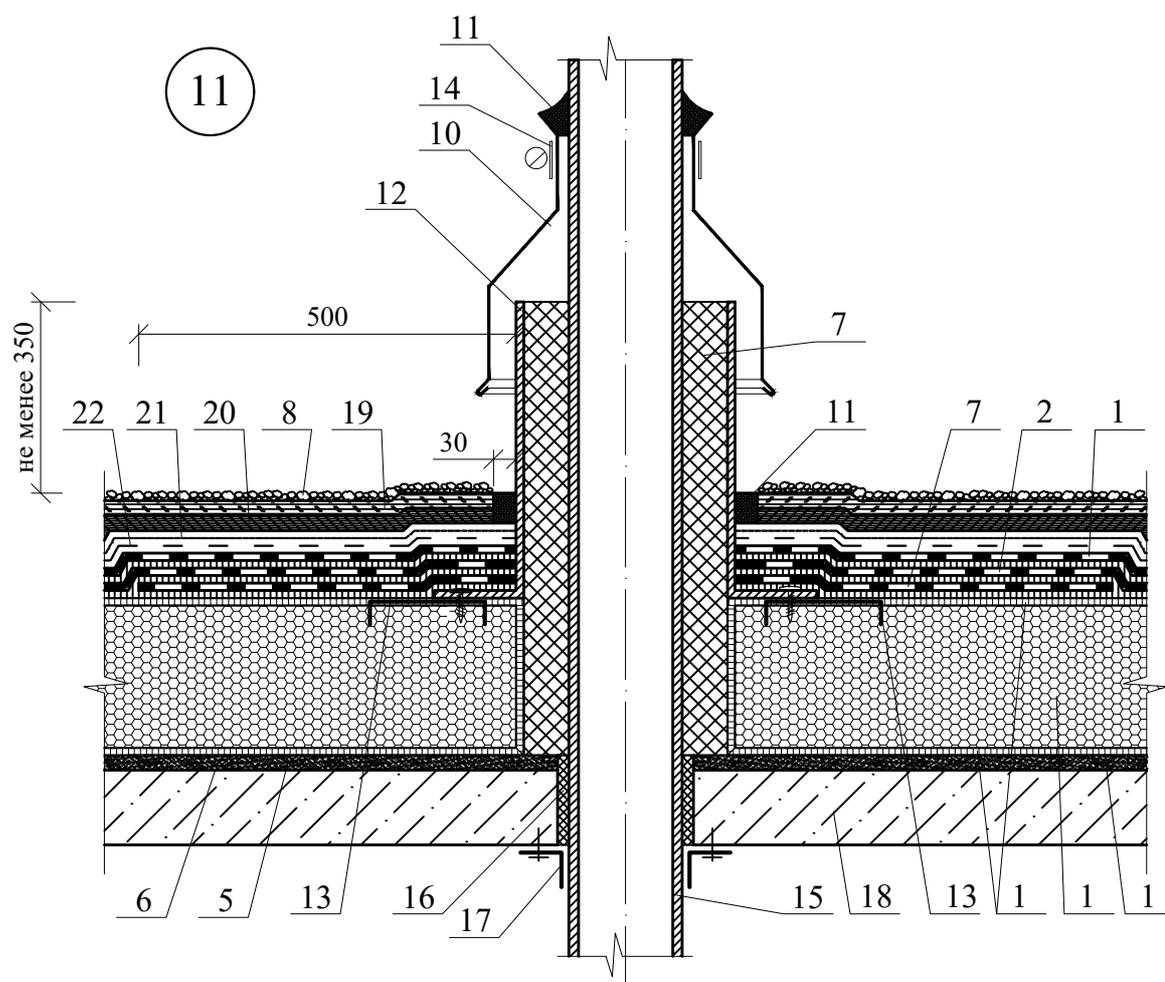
Узел 10 к рис.35. Примыкание кровли к "холодной" трубе
